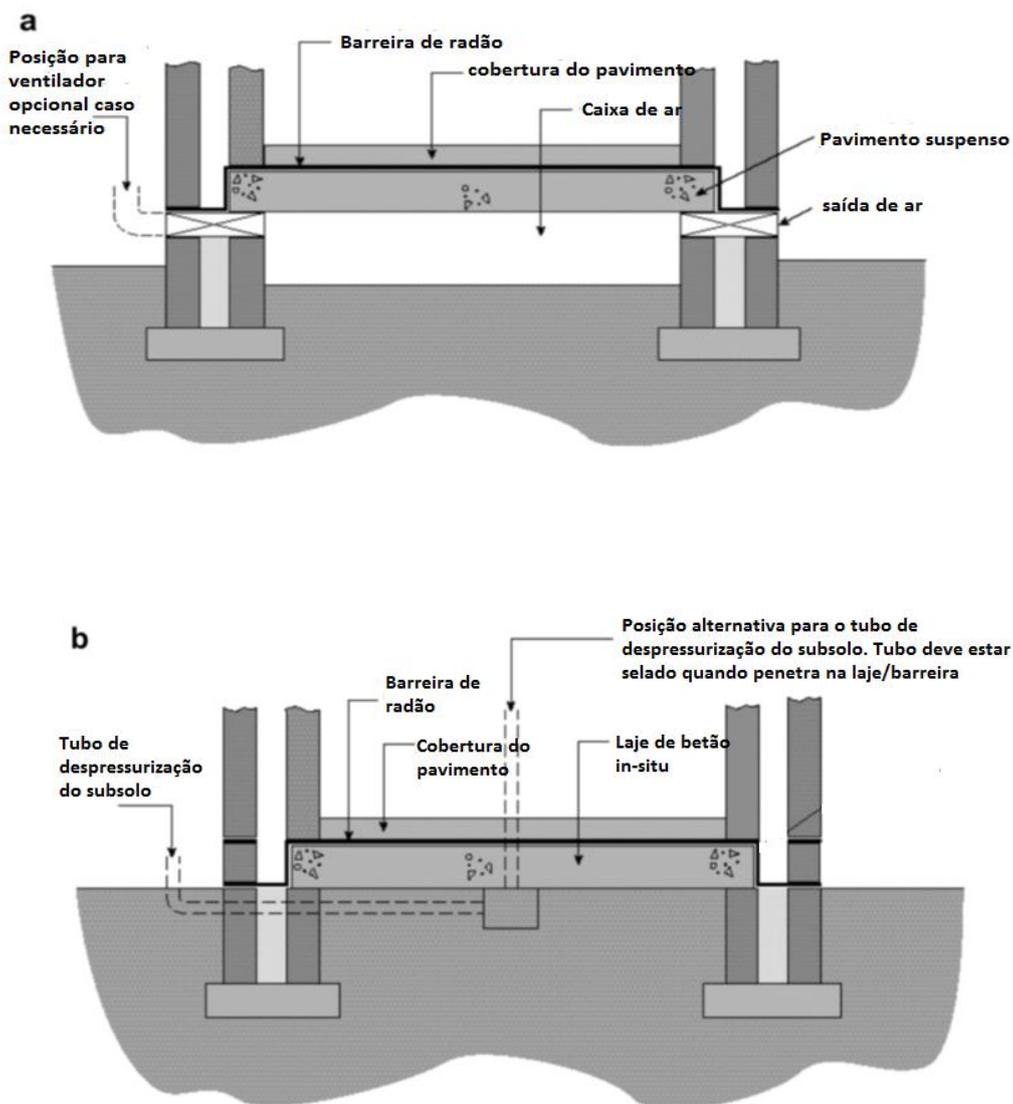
Proteção de radão: (a) para pavimento suspenso de betão; (b) para terreno contendo laje de pavimento em betão (Scivyer, 2001).
